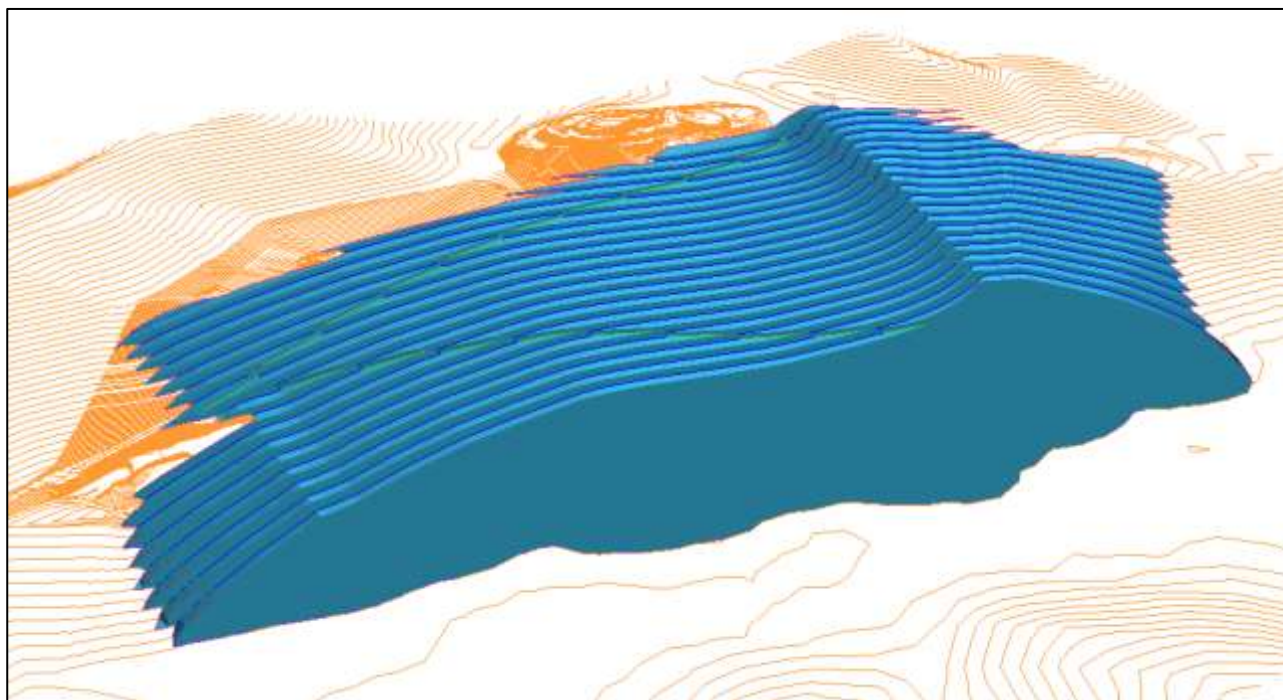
Configuração Final tridimensional da Cava 1.
